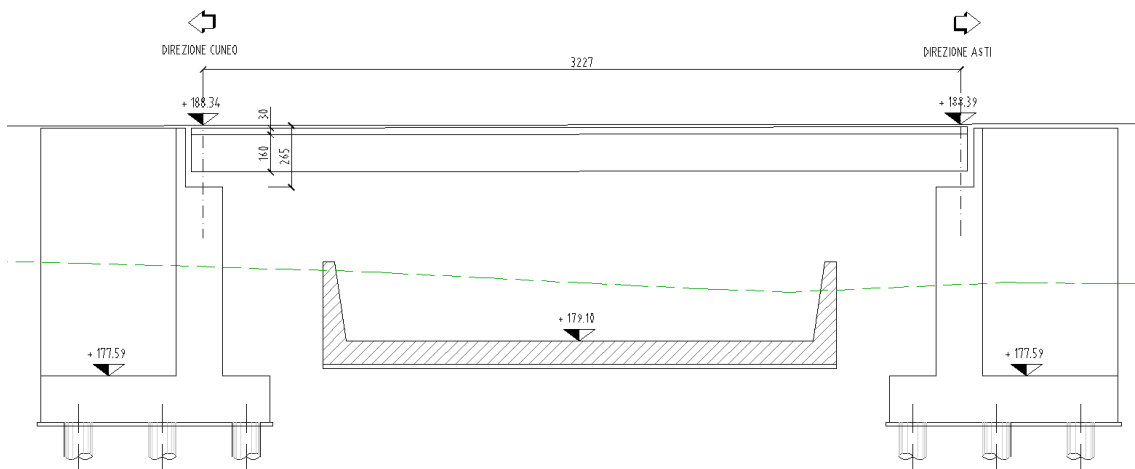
Attraversamento Canale ENEL: sezione longitudinale
